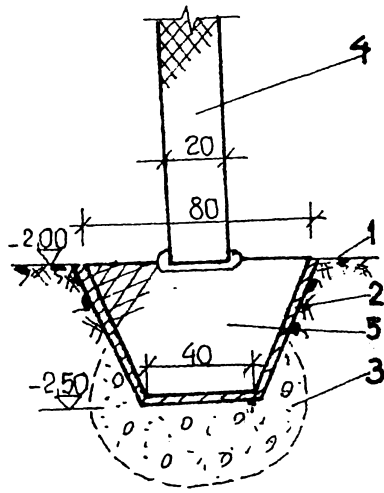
Soluția de fundare realizată; 1-săpătură generală; 2-element prefabricat din B 150; 3-bulb din balast; 4-elevație prefabricată; 5-beton pentru contact B150.
